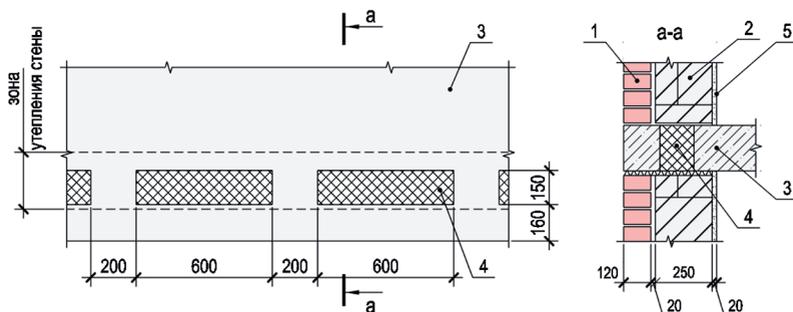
Стандартный узел сопряжения перекрытия с наружной стеной:
